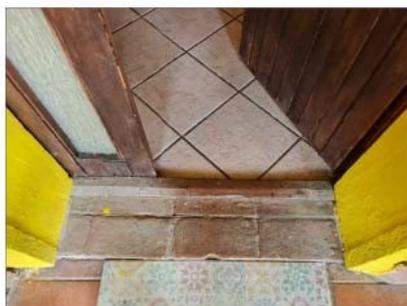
DETTAGLIO PAVIMENTO INGRESSO
